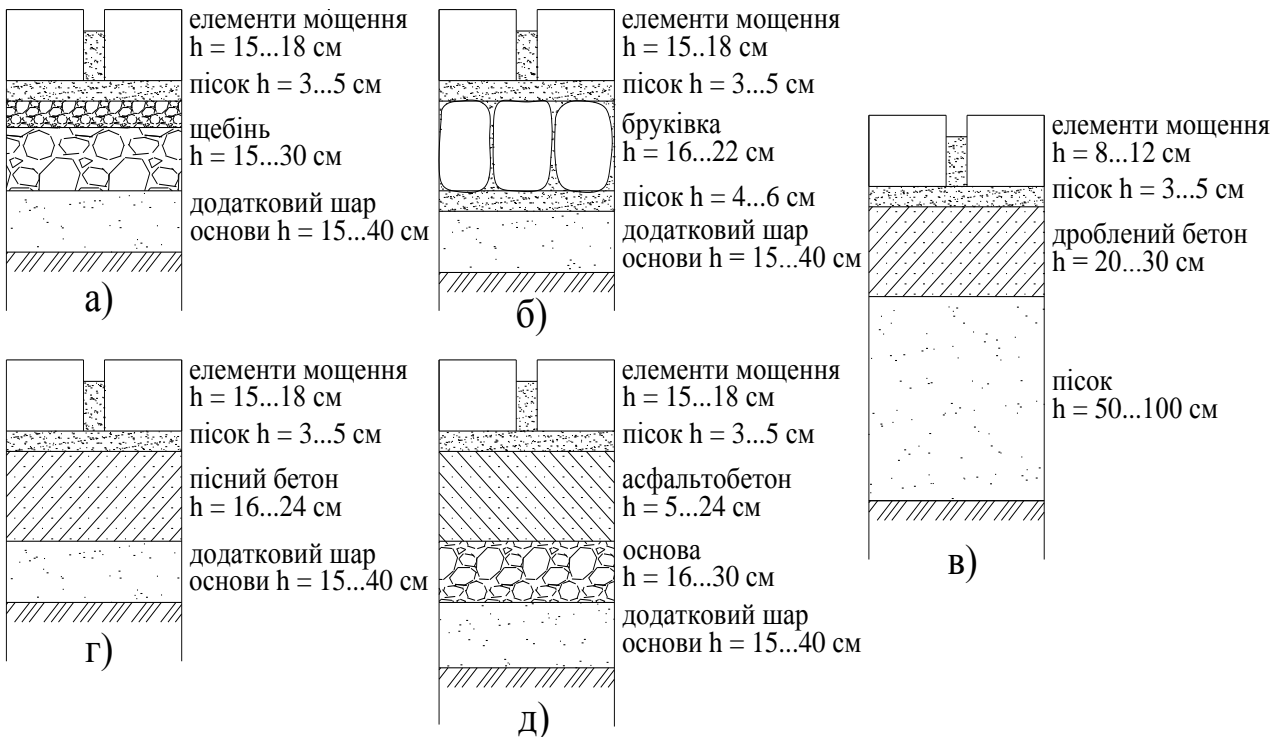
Приклади конструкцій ПЕМ, що зустрічаються в Польщі та Нідерландах та мають наступні основи: а) щебенева; б) з бруківки; в) з дробленого бетону; г) з пісного бетону; д) з асфальтобетону
